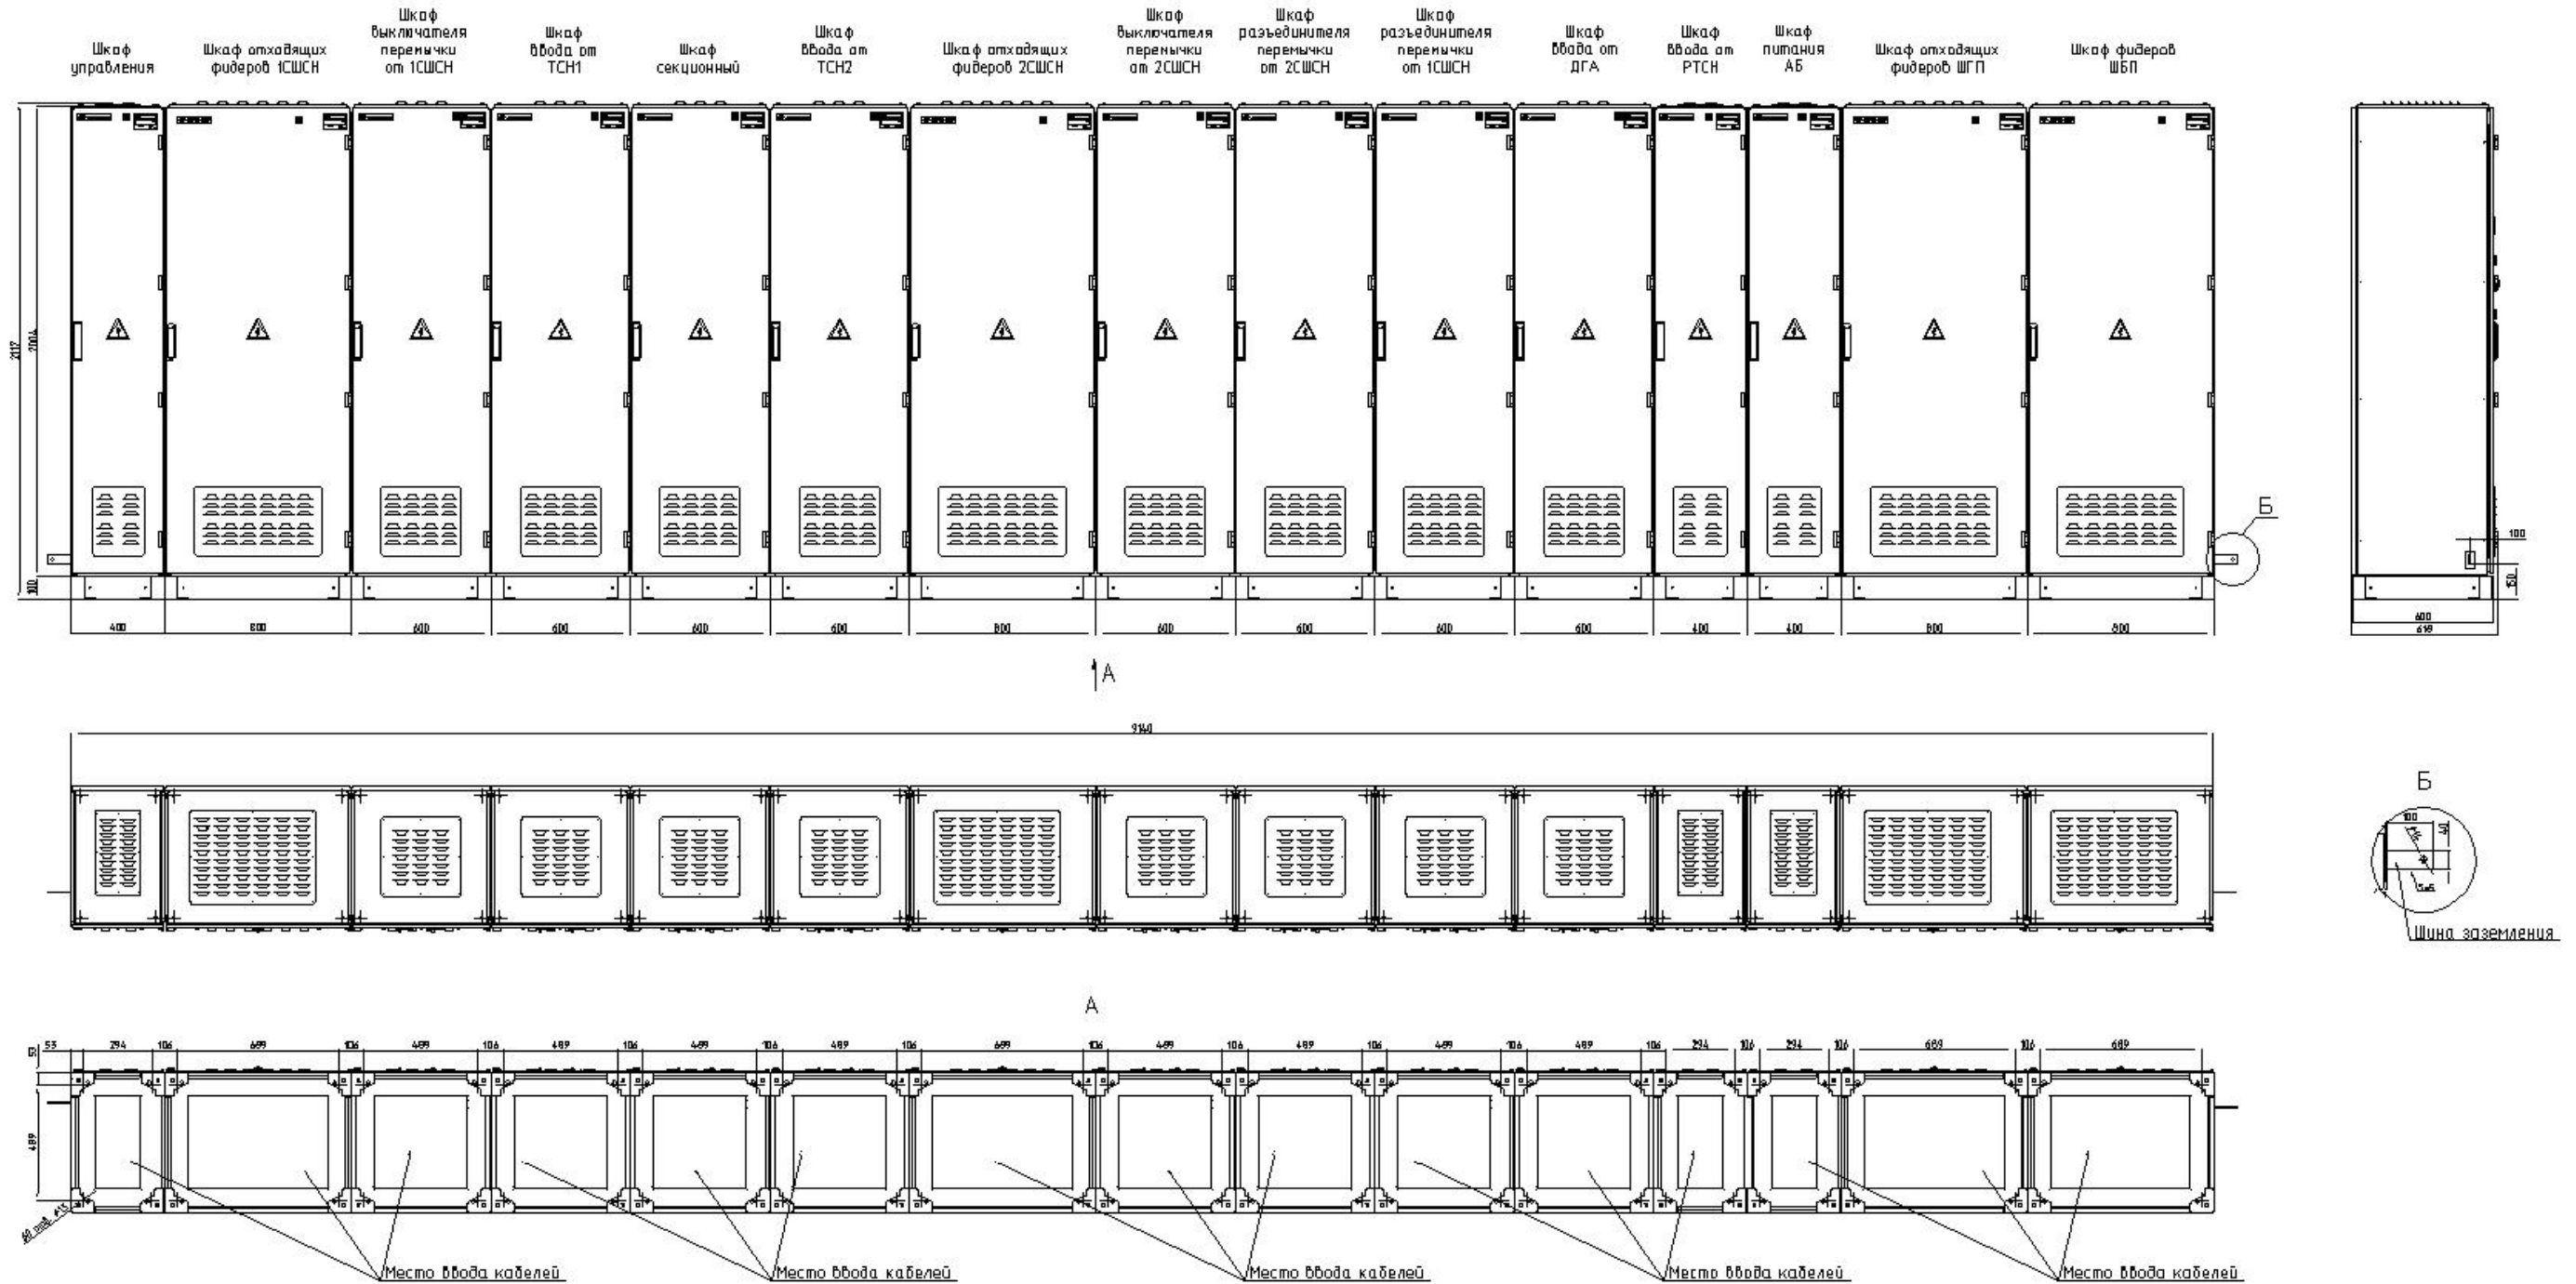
Габаритный чертеж блока СН переменного тока 1600 А (с цоколем 100 мм)
